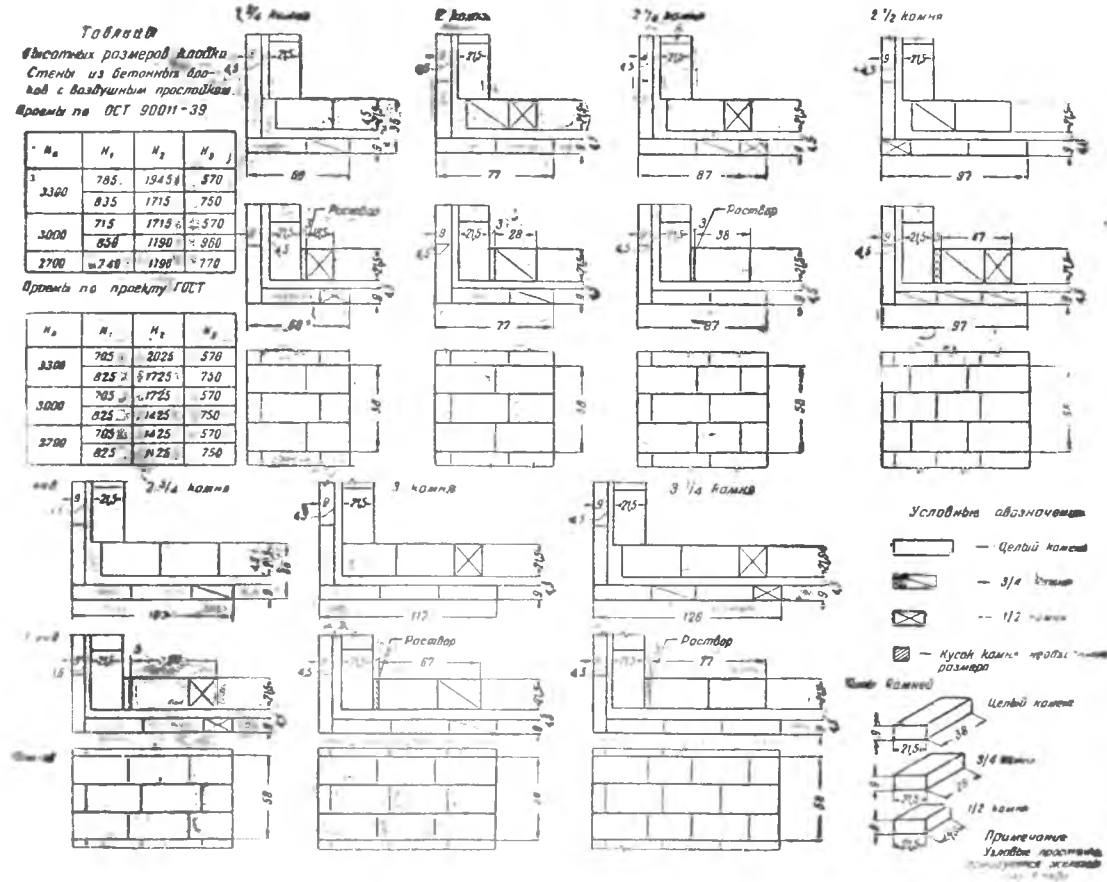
Стены с воздушным прослоем из разных блоков. Кладка углов
